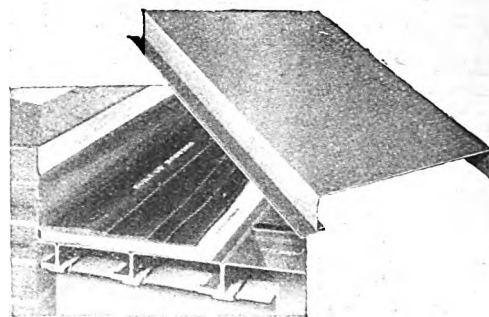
Amerikanische Dachkonstruktion aus Stahlblechen.
